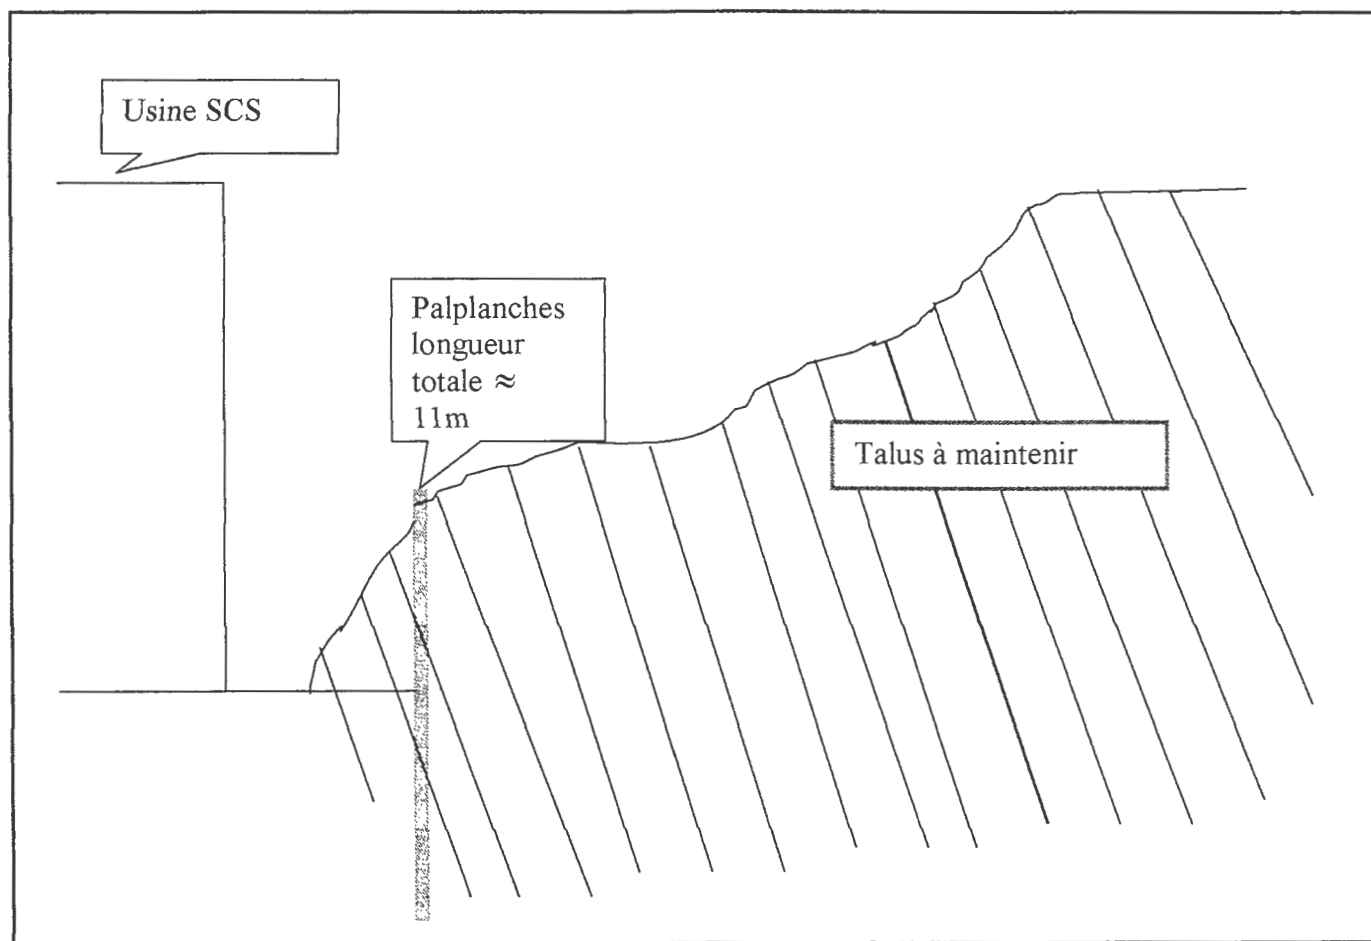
Coupe schématique d'implantation des palplanches
